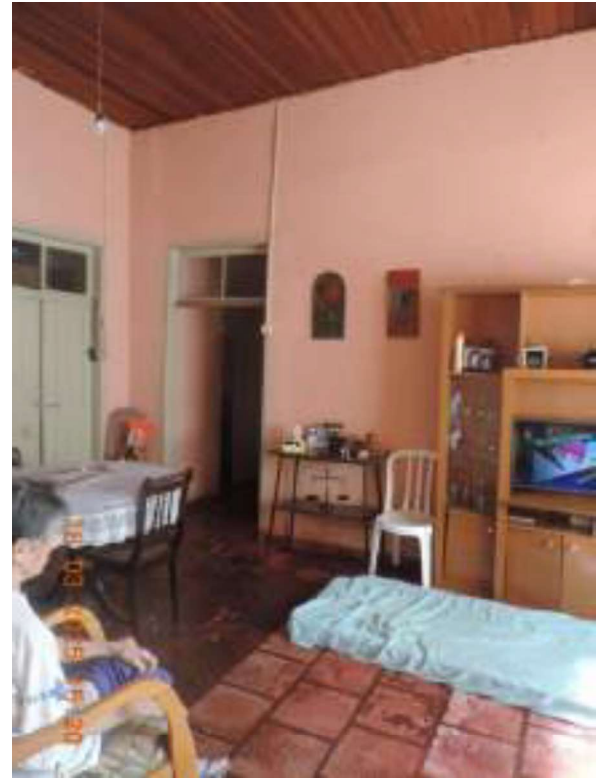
VISTA INTERNA DA EDIFICAÇÃO PRINCIPAL
